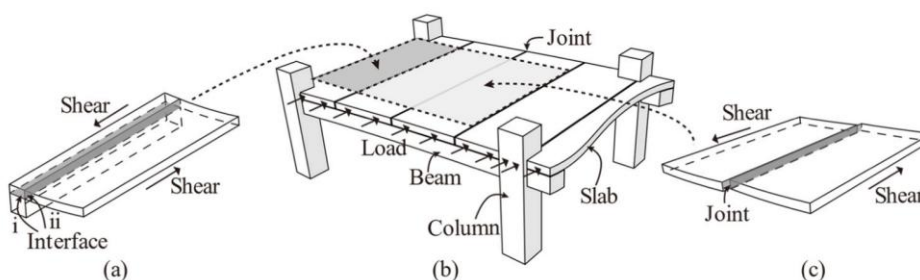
Esquema representativo dos mecanismos de corte no plano em lajes pré-fabricadas: (a) corte viga-laje; (b) corte no plano do pavimento; (c) corte laje-laje [16]
